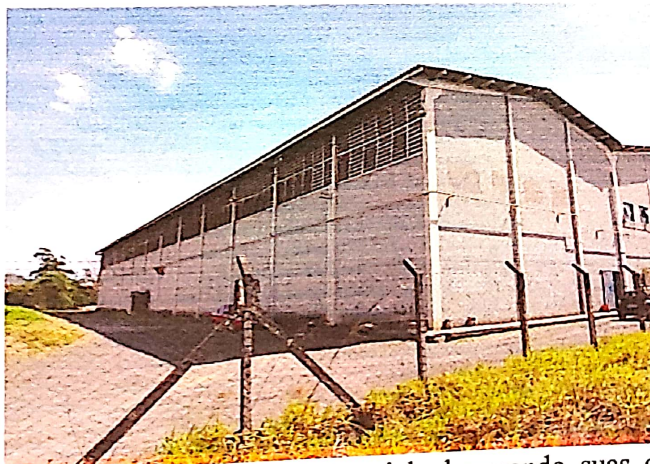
Vista geral do Barracão Industrial observando suas características construtivas.
